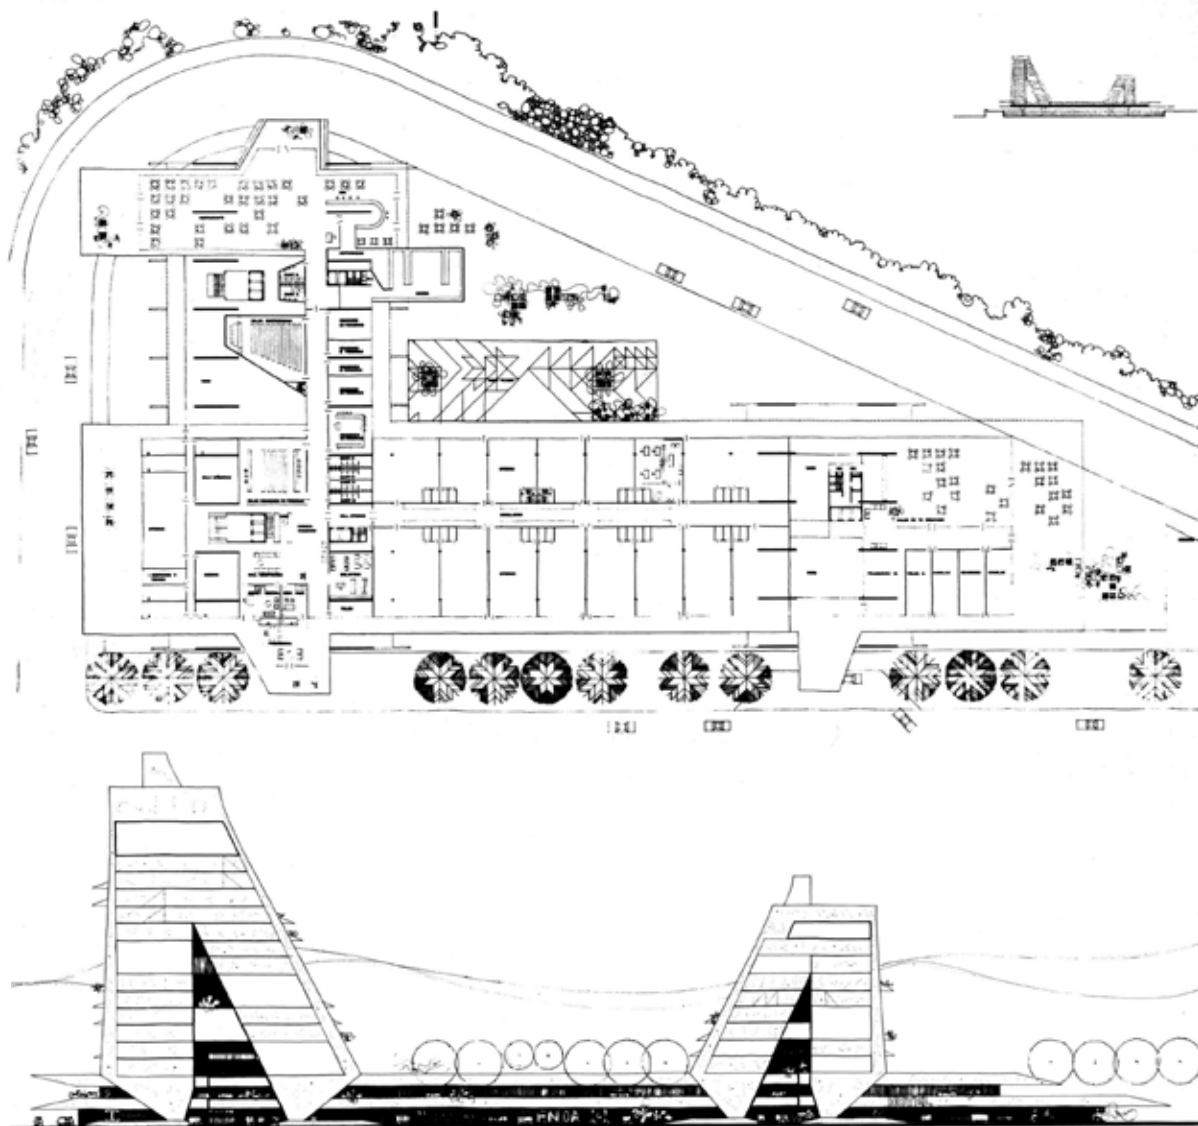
Euro Kursaal; Projeto B; planta 2º pavimento (embasamento). Fig. 702a: elevação lateral face sul.
